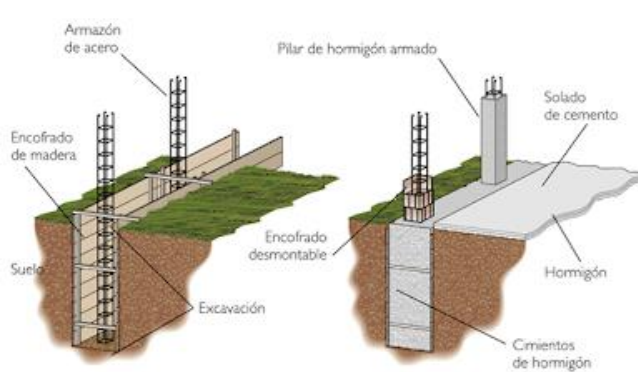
1. Sistema Constructivo de Hormigón Armado
